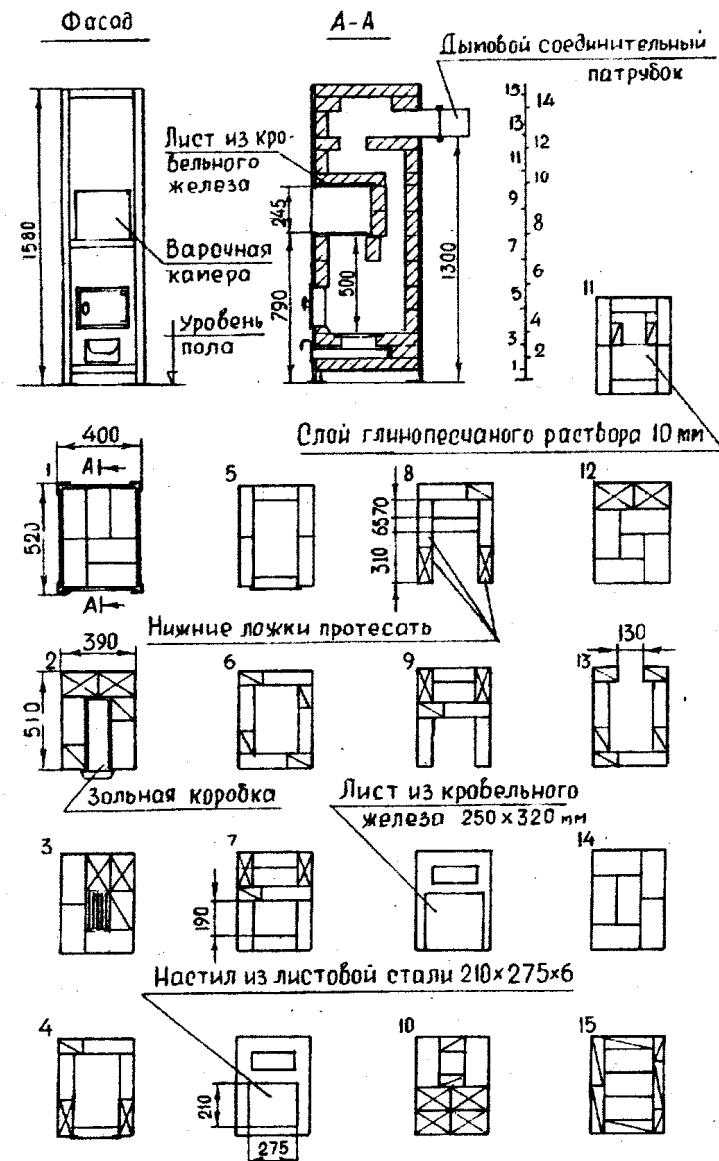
Кладка каркасной отопительно-варочной печи с открытой варочной камерой
